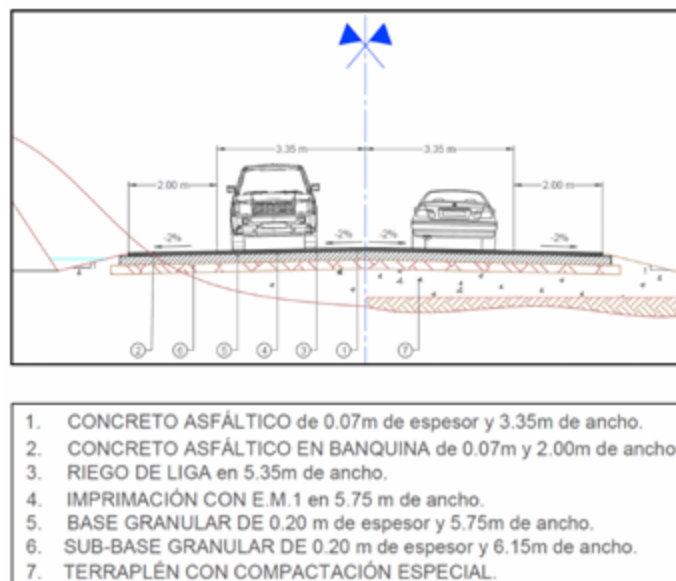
Perfil tipo de la sección transversal proyectada en los caminos de acceso al túnel
